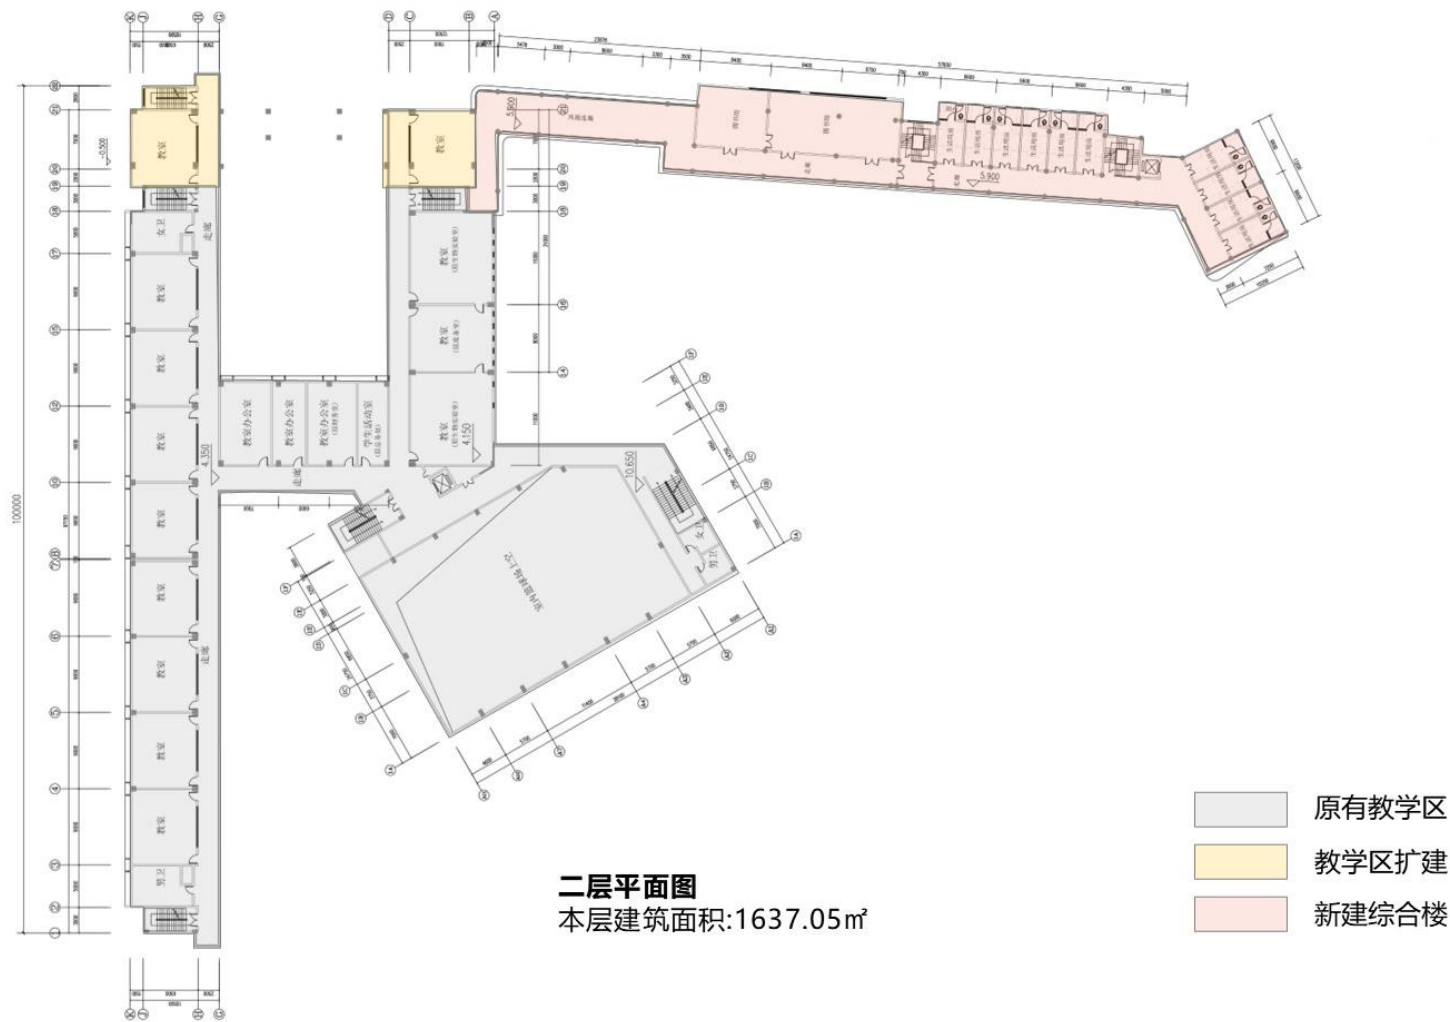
新建综合楼及电梯工程二层改造平面图
